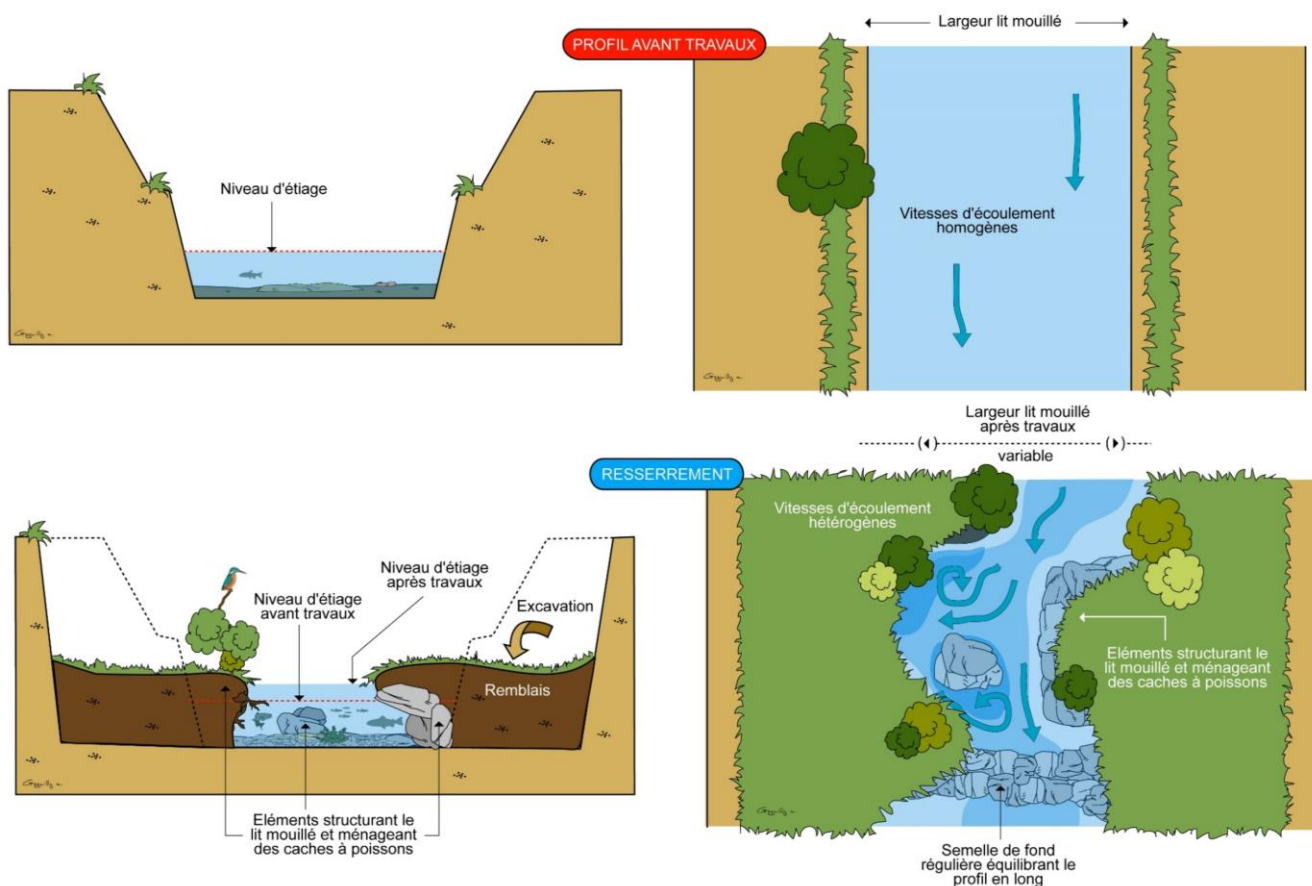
Schémas illustrant en coupe et en plan le principe d'une réhabilitation au sein du lit moyen d'un cours d'eau.
